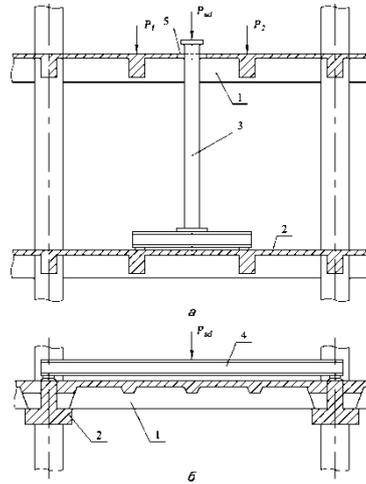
Полная передача дополнительной нагрузки на другие конструкции: а – посредством стоек на нижерасположенное перекрытие; б – посредством распределительной балки на ригели перекрытия; 1 – разгружаемая конструкция; 2 – конструкция, на которую передается дополнительная нагрузка; 3 – стойка; 4 – распределительная балка; 5 – отверстия в перекрытии
